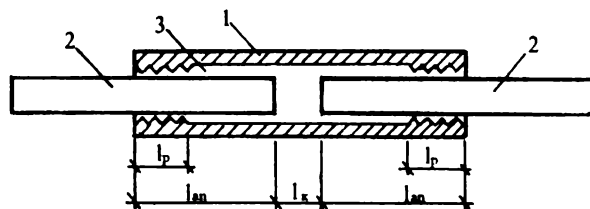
Опытные образцы клеевого соединения сборных железобетонных конструкций
